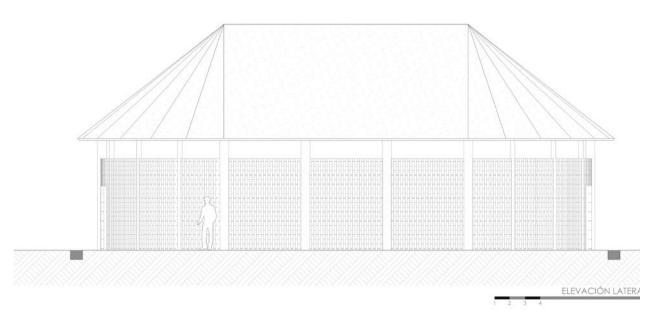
Planos arquitectónicos\_ Vivienda shuar Elaborado por: El autor
